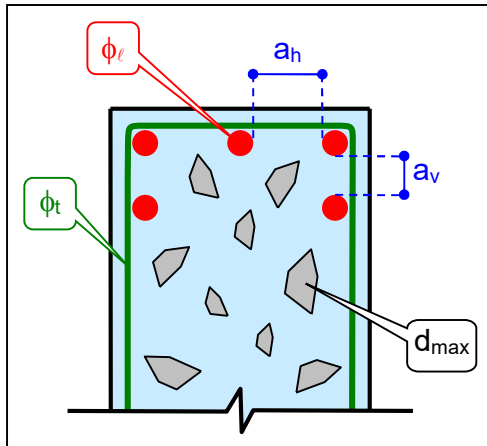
Espaçamento horizontal e vertical de barras longitudinais
